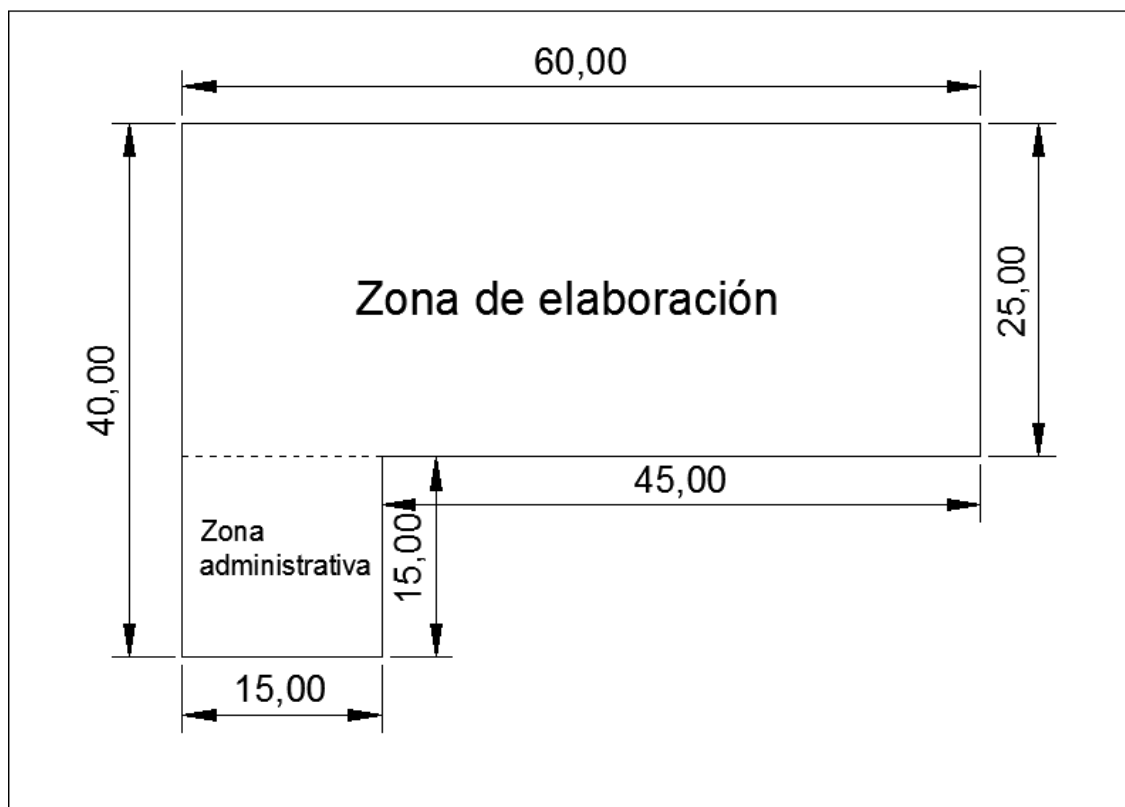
Plano de la planta a nivel $\pm 0.00\text{ m}$.
